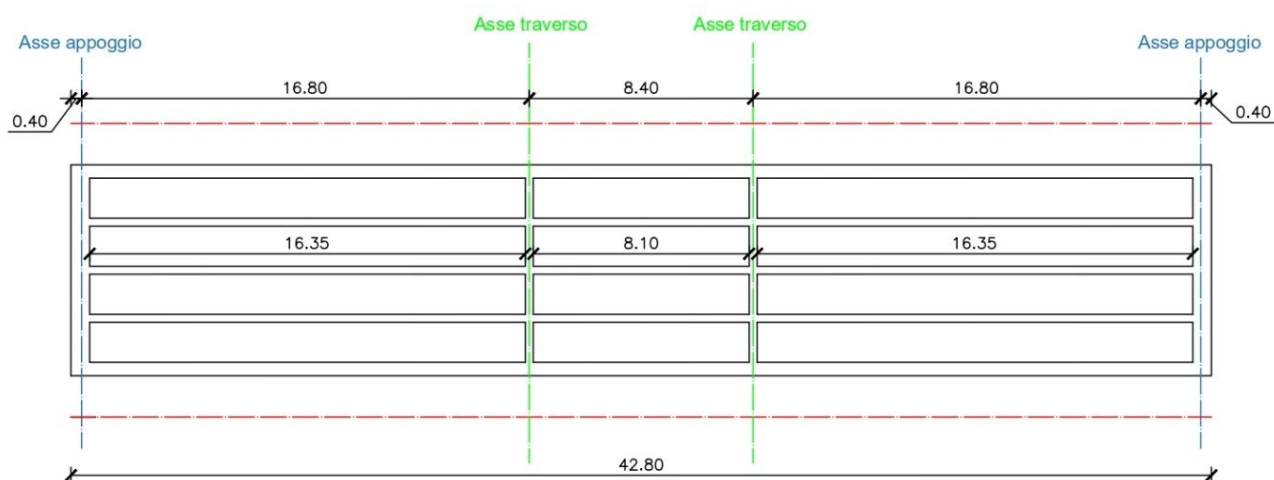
Planimetria dell'impalcato, rappresentata senza inclinazione (misure in [m])
